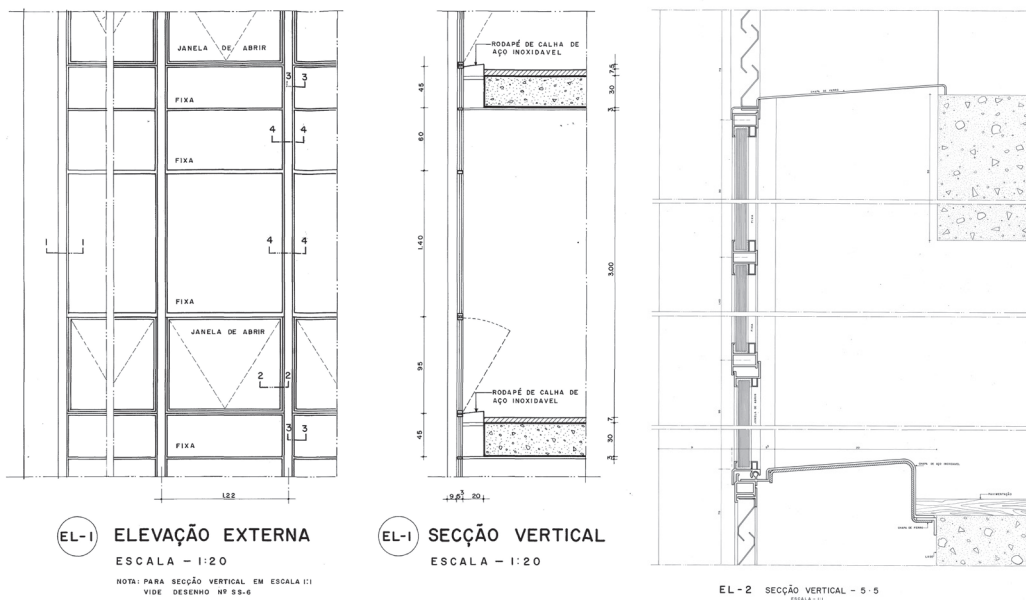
Vista, corte e detalhe do afastamento da esquadria em relação à estrutura de concreto. Fonte: desenhos originais de Garcia Roza.
